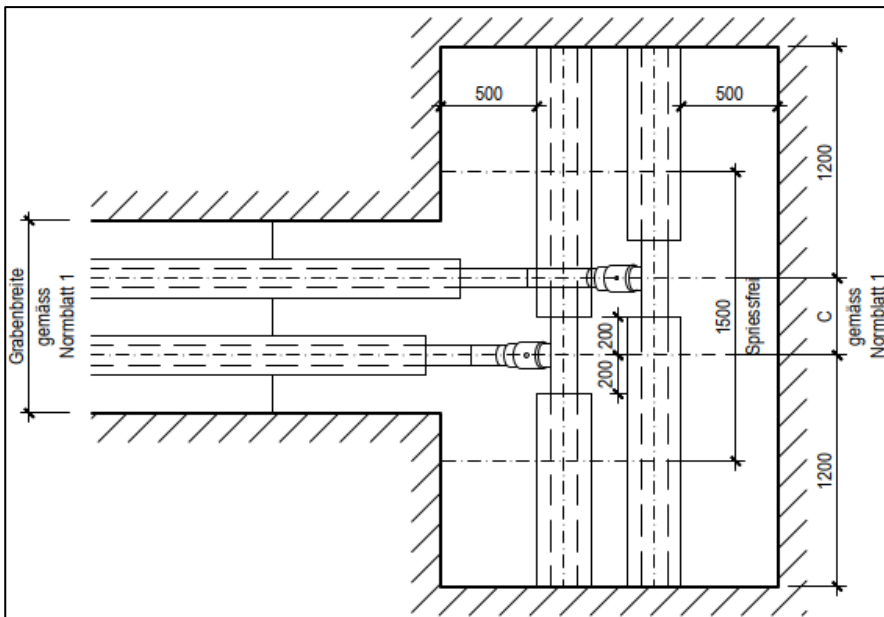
Grundriss – Ausführung nach unten
